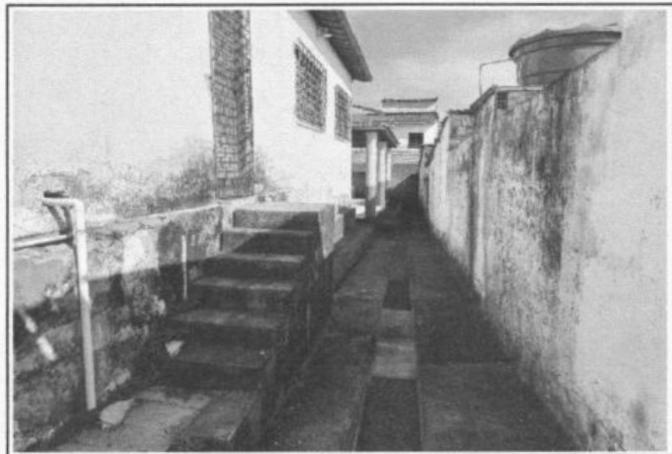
DRENAGEM NECESSITANDO DE IMPERMEABILIZAÇÃO
